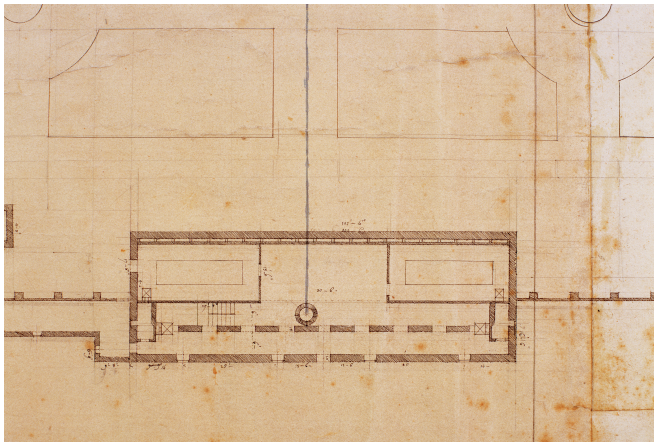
Grundriss des Gewächshauses von 1755 (BSV, Bauabteilung).
